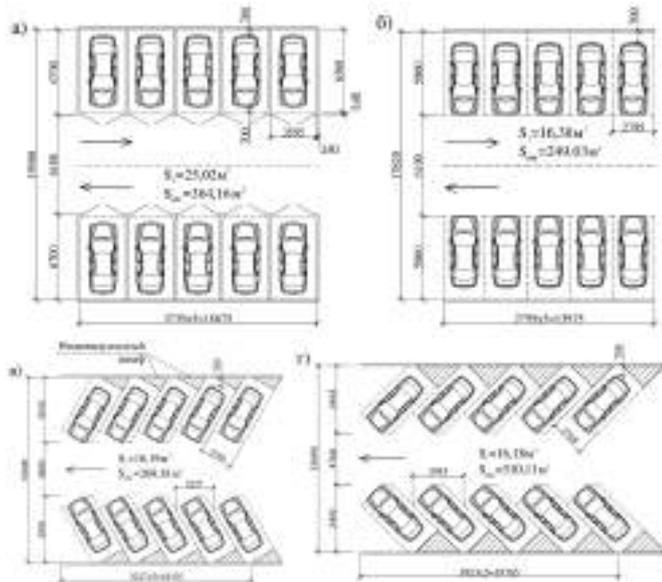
Фрагменты планов расстановки 10-и автомобилей большого класса: а) боксовое хранение; б) манежное хранение с расстановкой под углом 90°; в) манежное хранение с расстановкой под углом 60°; г) манежное хранение с расстановкой под углом 45°
